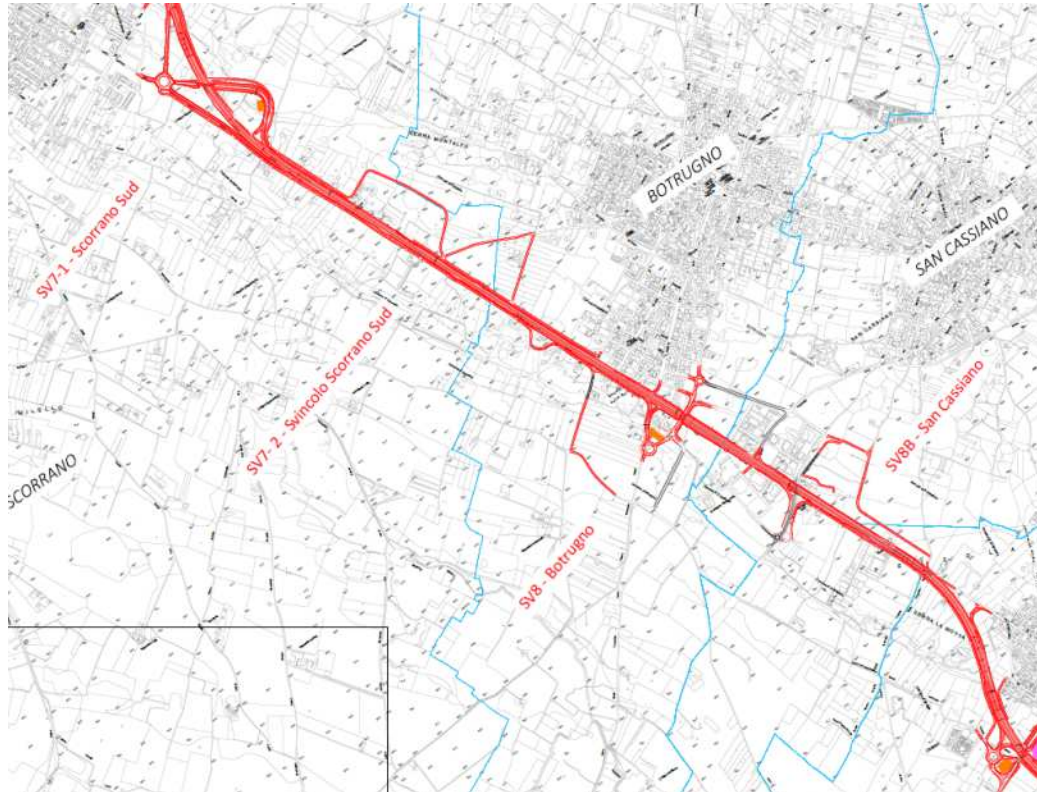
Planimetria complessiva dell'intervento su base CTR – 3 di 5
